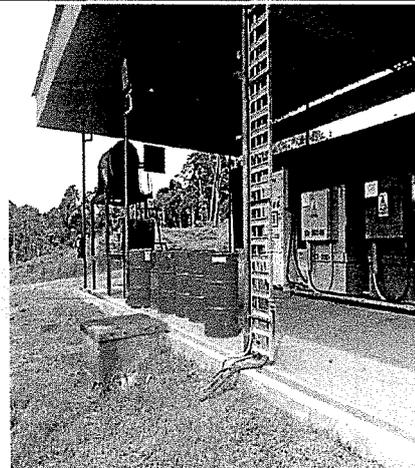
E350332 N9680587 (PSAD 56) / Locación del pozo Tambo 04.
